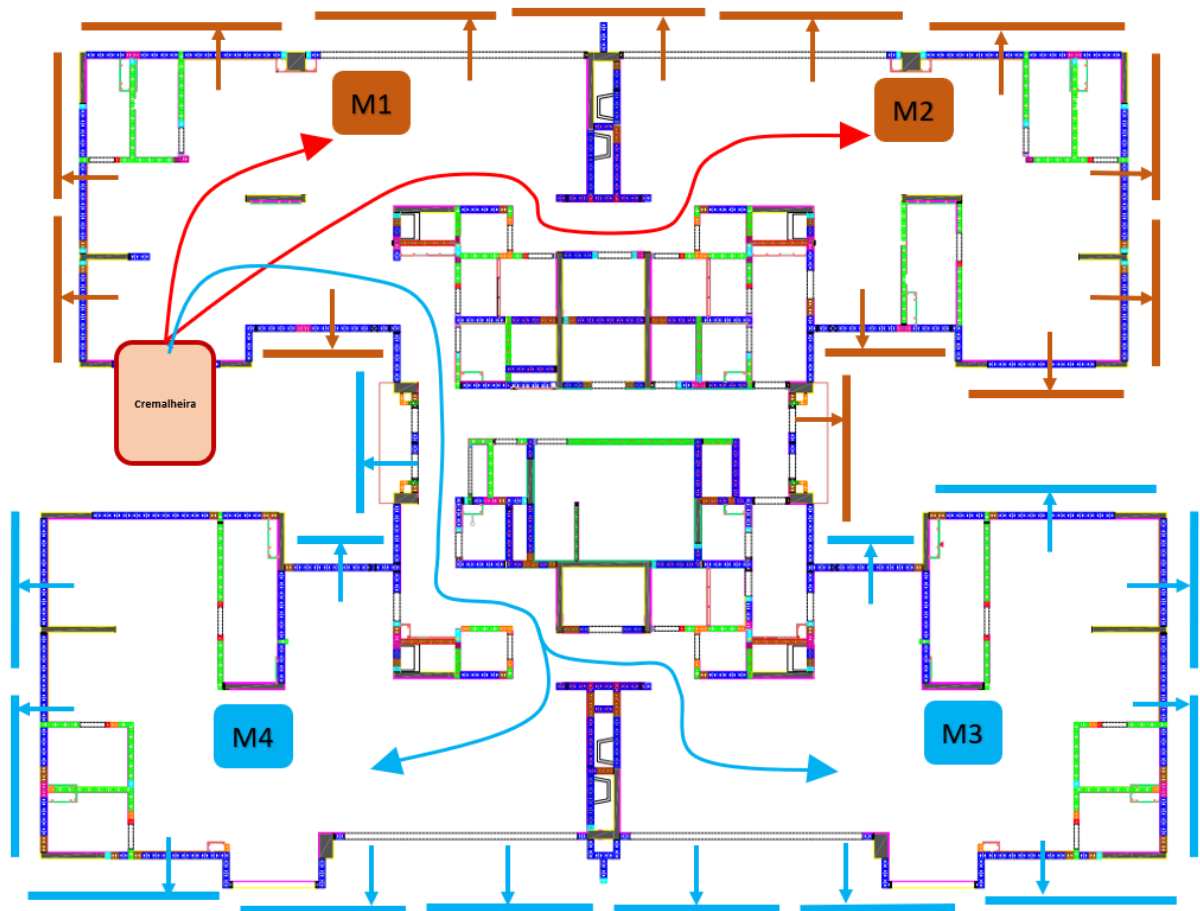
Apresentação do 17º pavimento. (fonte: elaborado pelo autor)
